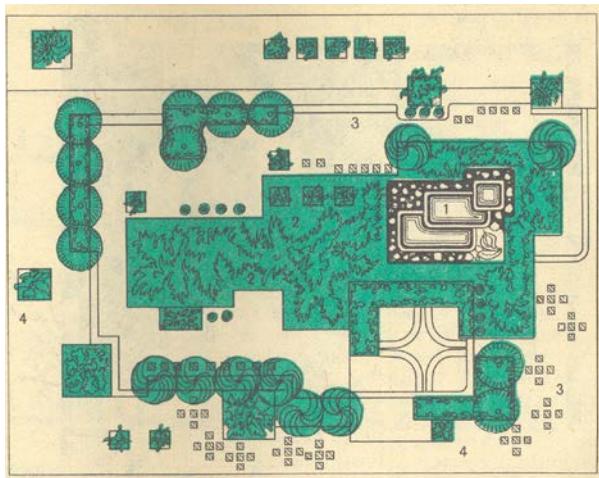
Сад на крыше административного здания в г. Зульбах (Германия): 1 – фонтан; 2 – газон; 3 – скамьи, стулья; 4 – остекленные стены
